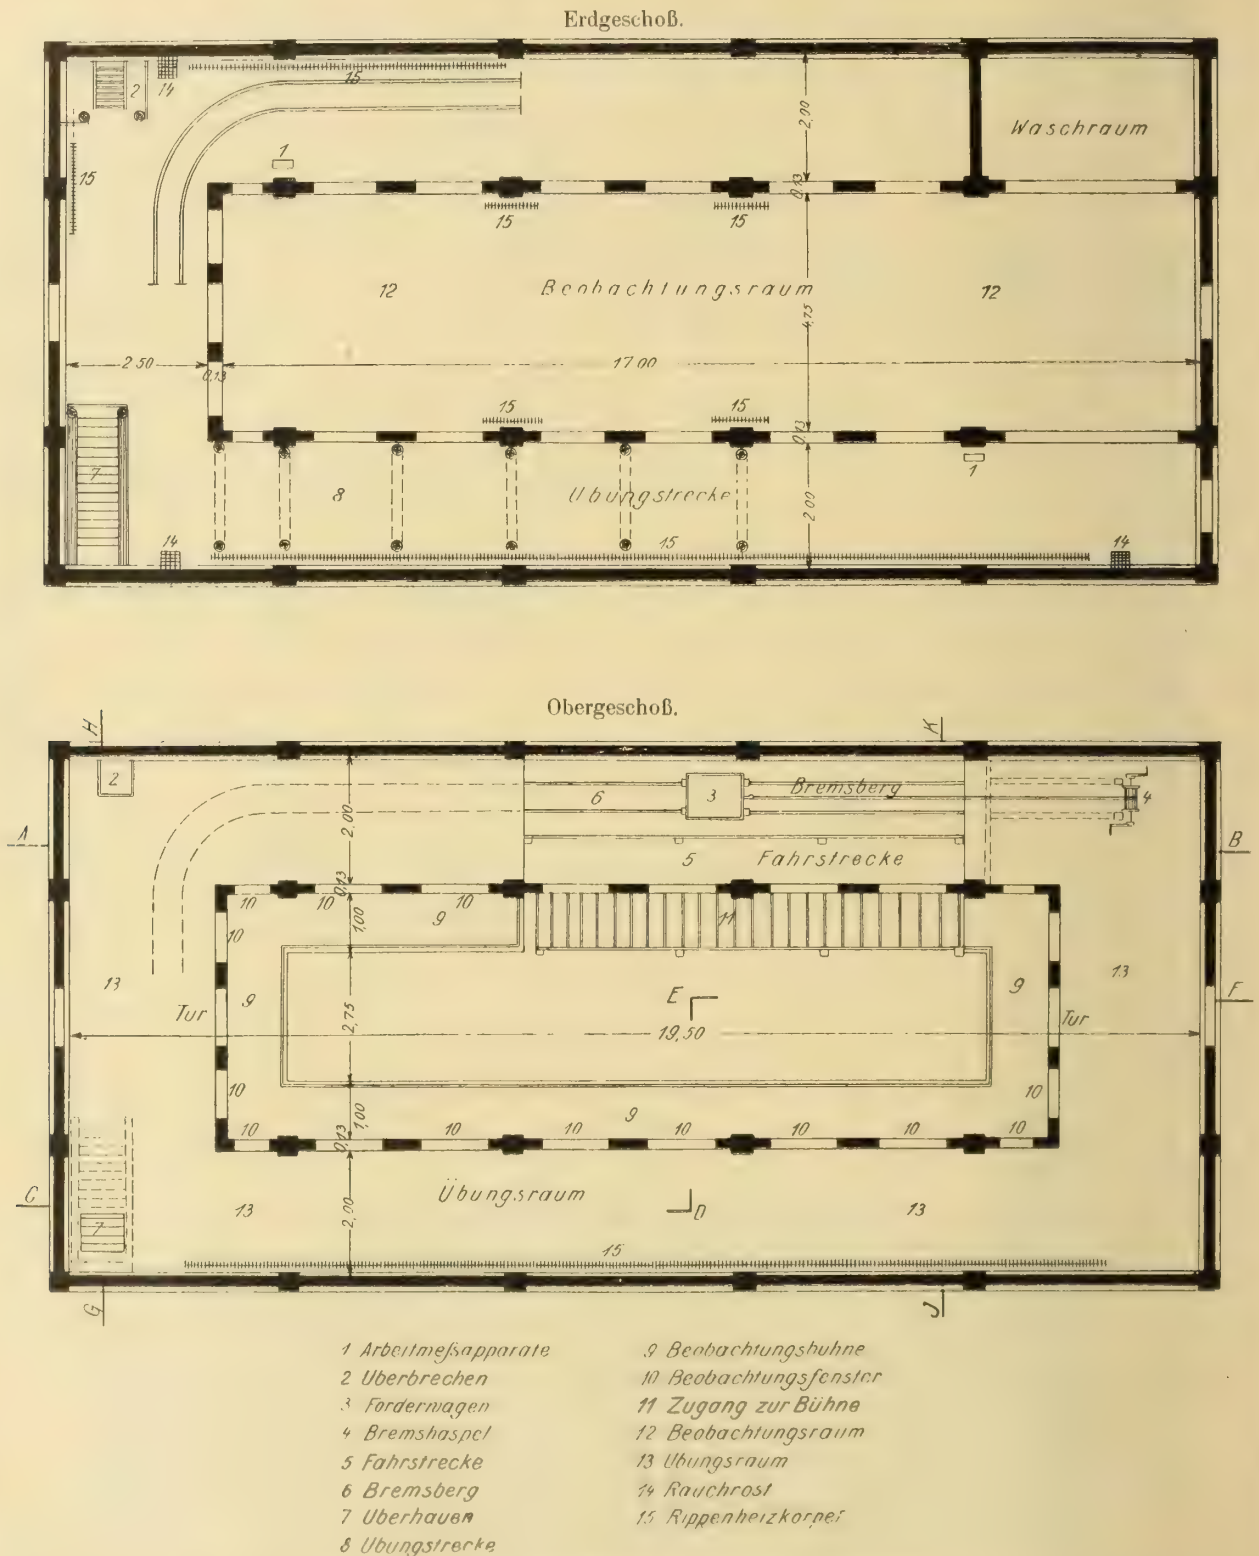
Erd- und Obergeschoßgrundrisse des Übungshauses.
